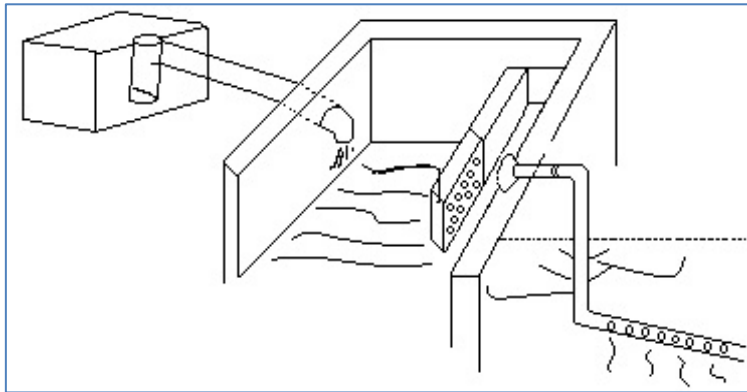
Tanque de Decantación. Fuente: Elaboración propia, J.A. Mancebo.
